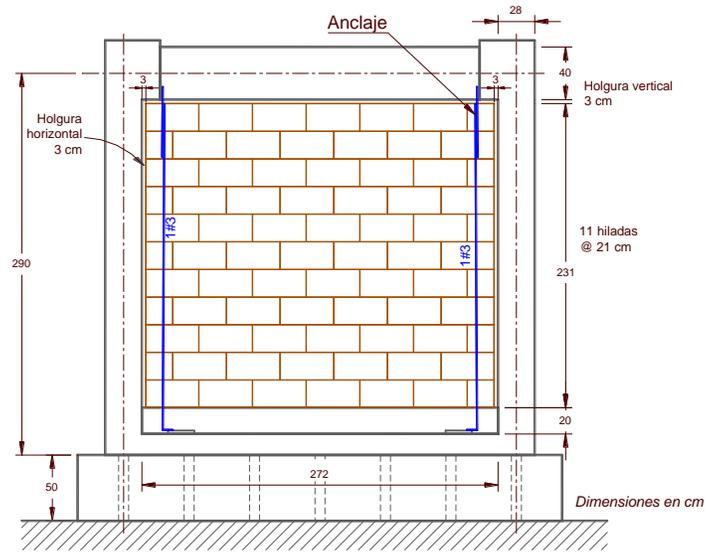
Muro MFP-1, no estructural dentro de un marco de concreto (desligado)
